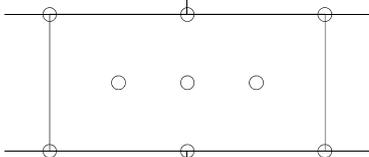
Panneaux de dimensions 1200 × 600 mm - plans de chevillage « en plein »
